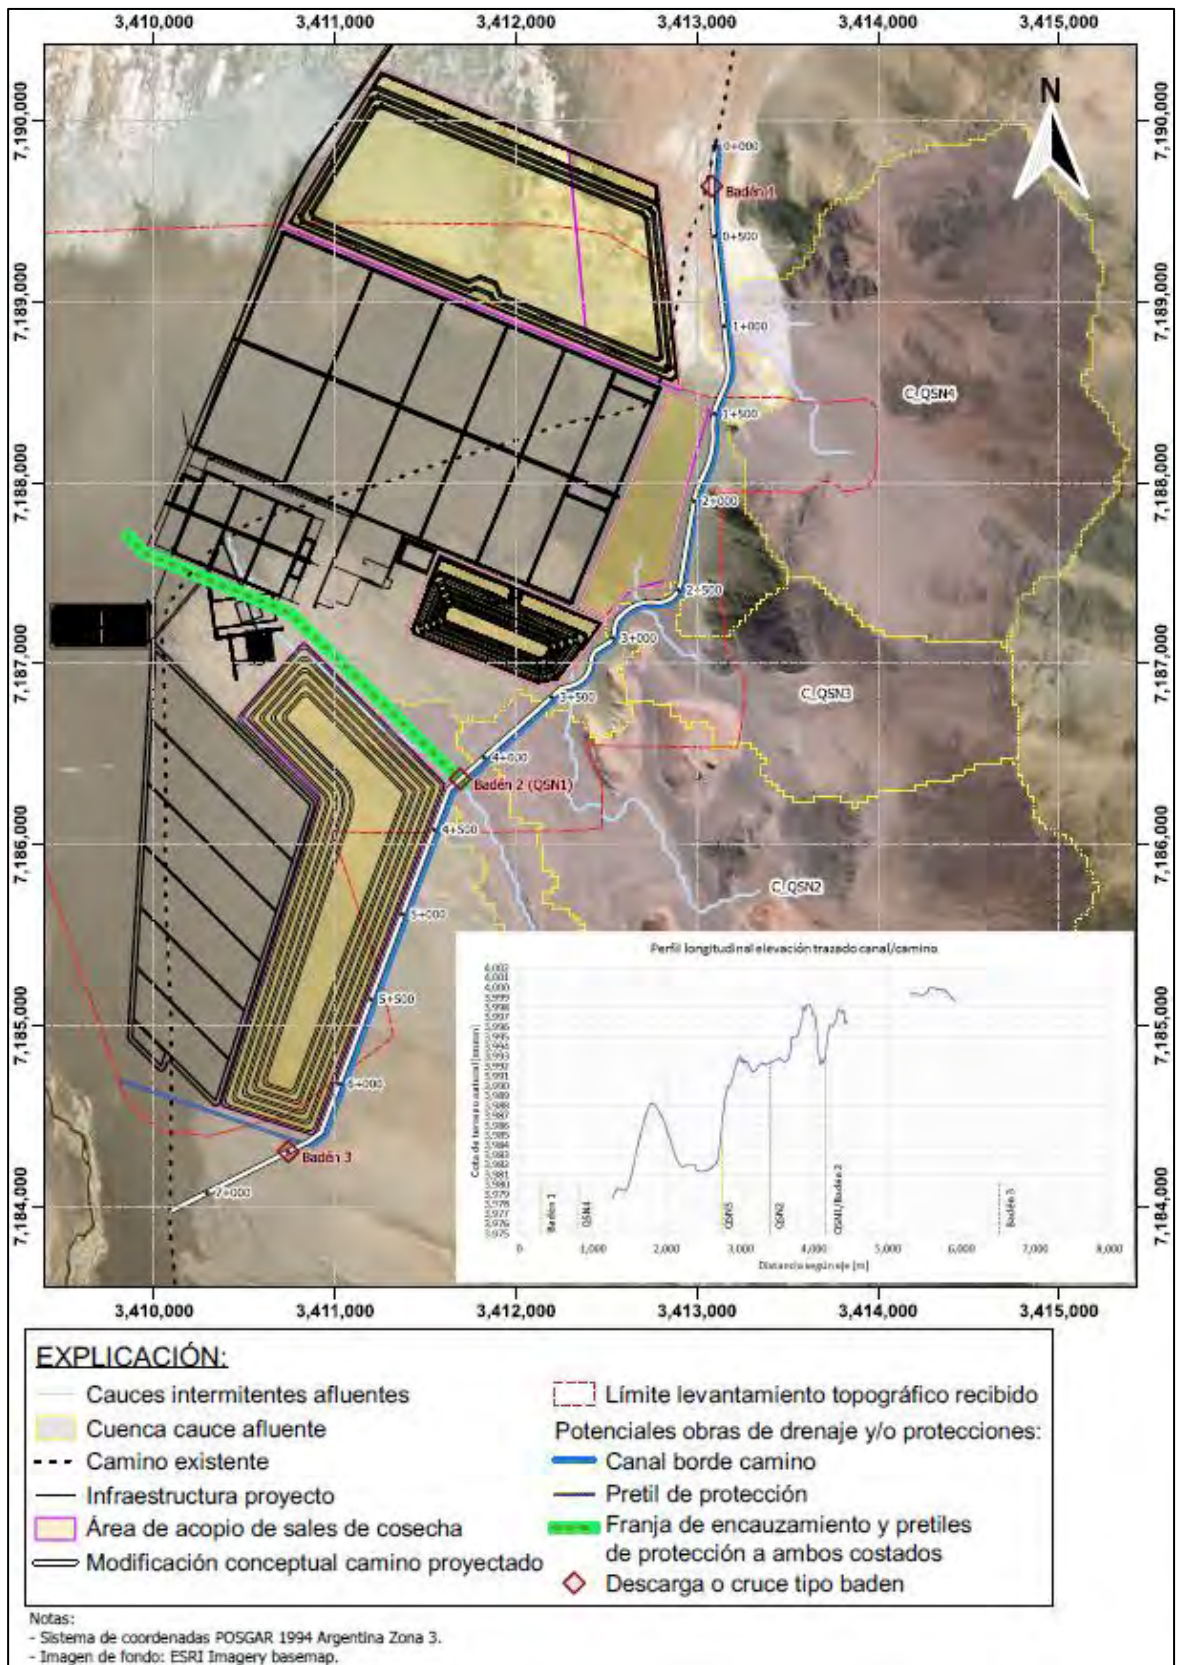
Escorrentías de superficie, infraestructura del Proyecto y obras de protección.
